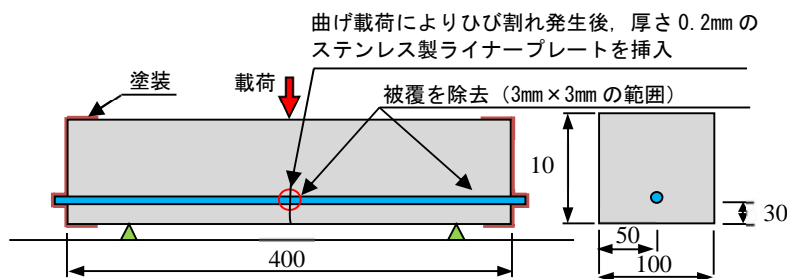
供試体形状図（エポキシ樹脂塗装鉄筋、ひび割れ有）
